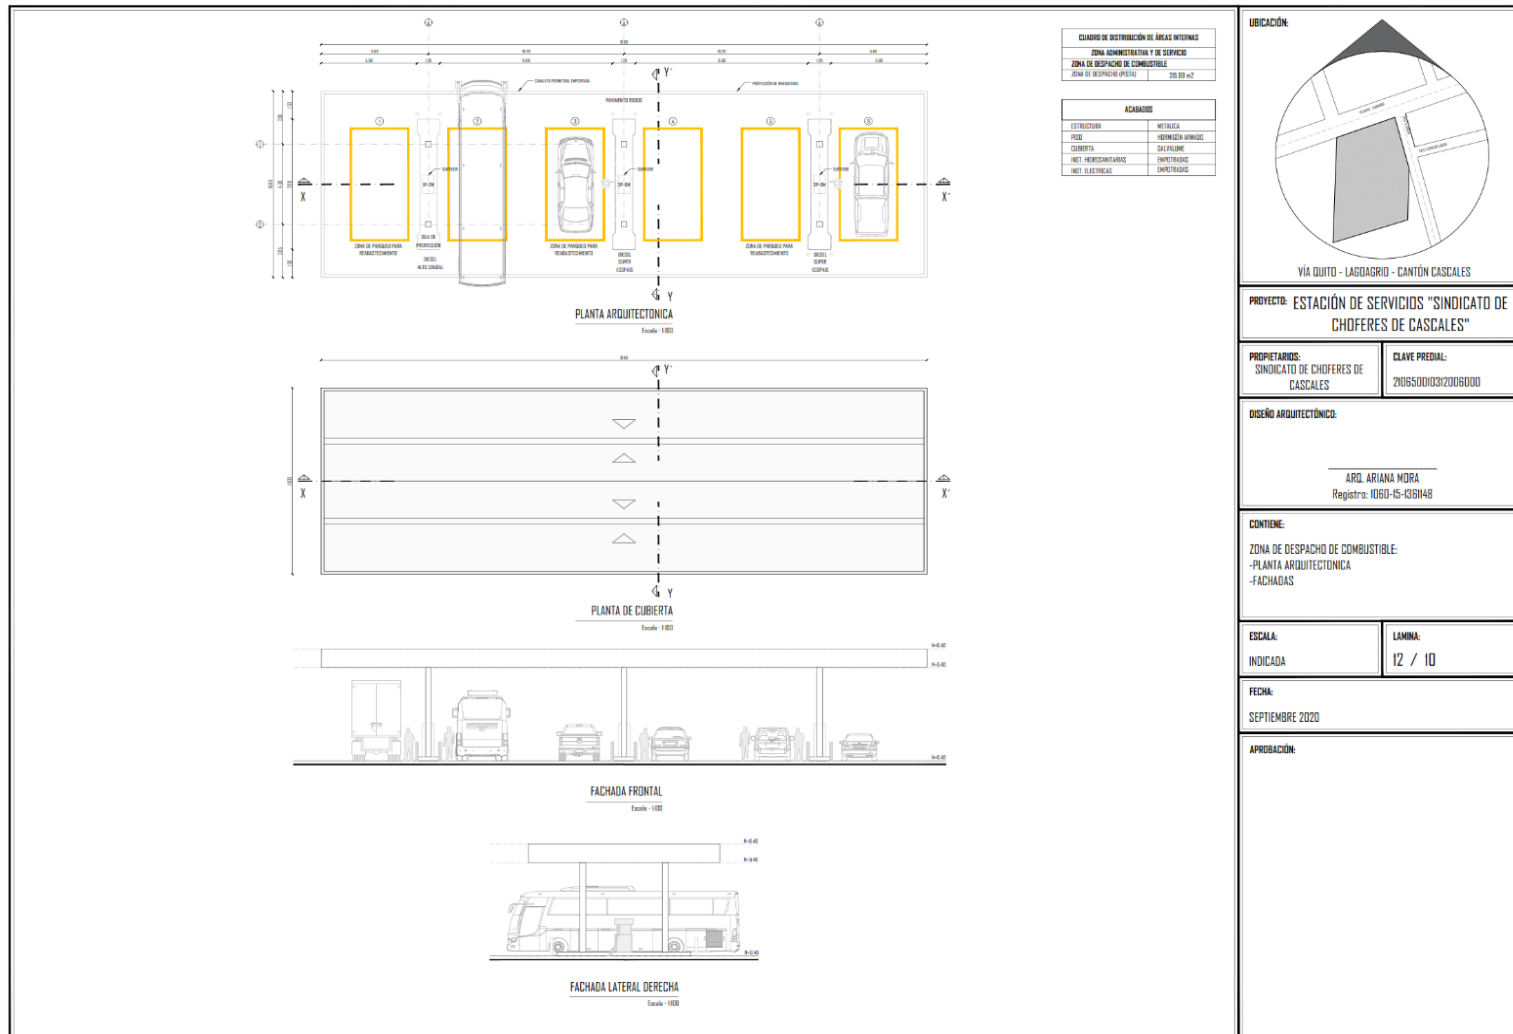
Plano de Instalaciones surtidoras. Fuente: Plano arquitectónico
